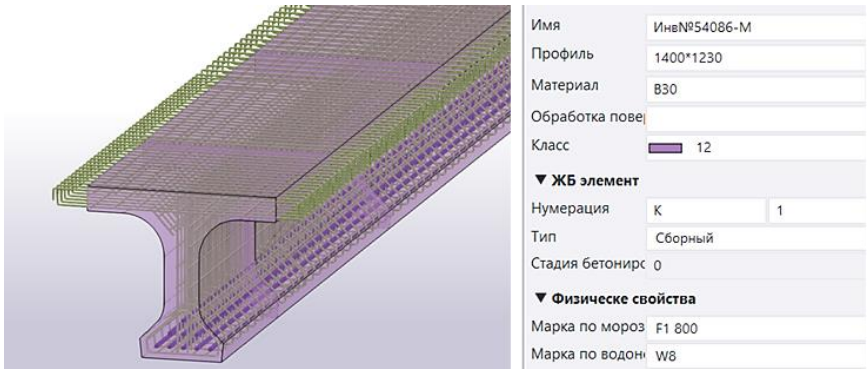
Фрагмент ЦИМ железобетонной балки, использованной в проекте
